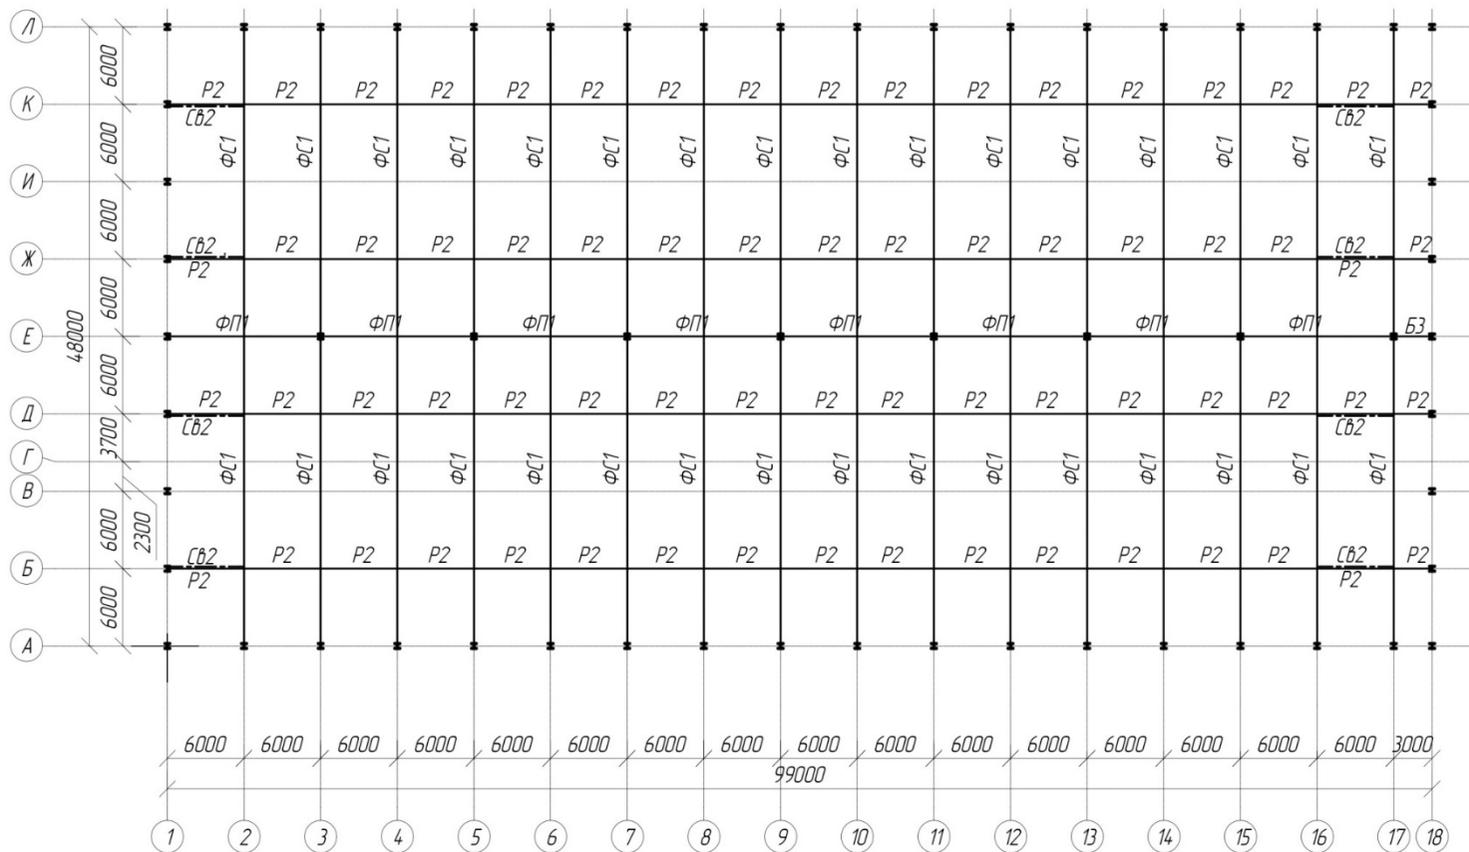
Схема расположения связей по нижним поясам стропильных ферм в осях 1-18/А-Л
